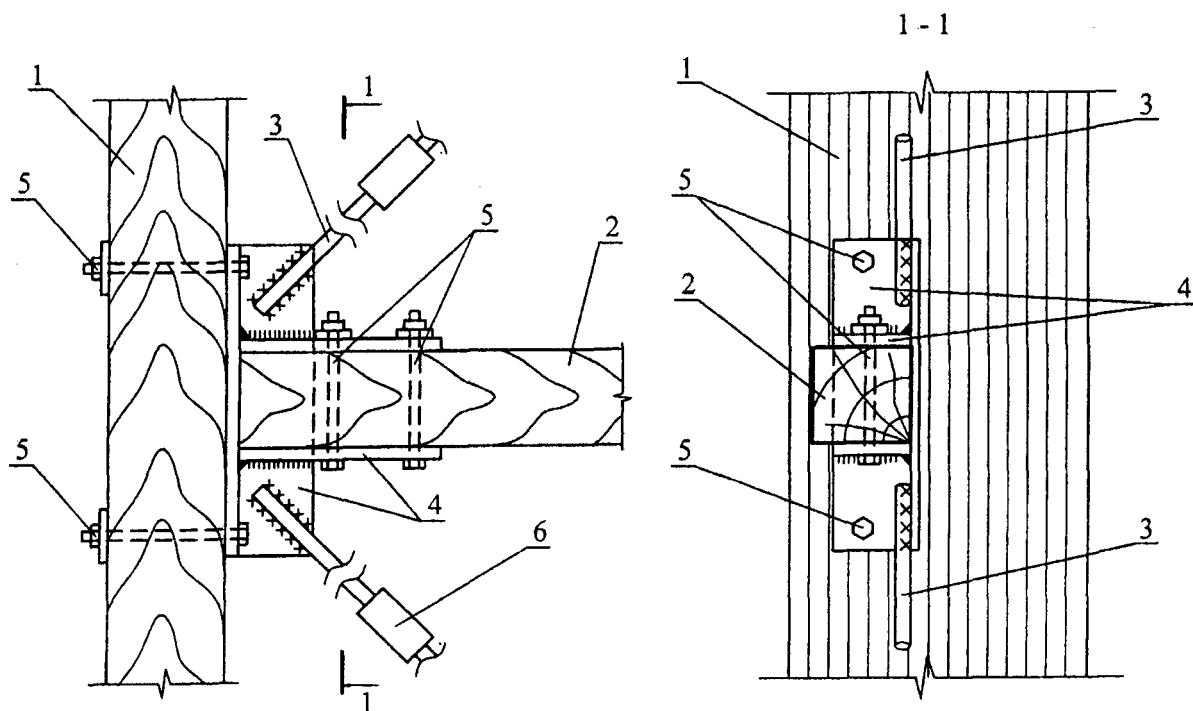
Вариант конструктивного решения горизонтальных связей в покрытии из деревянных плоскостных конструкций (узел 1 на рис. 5.26):
